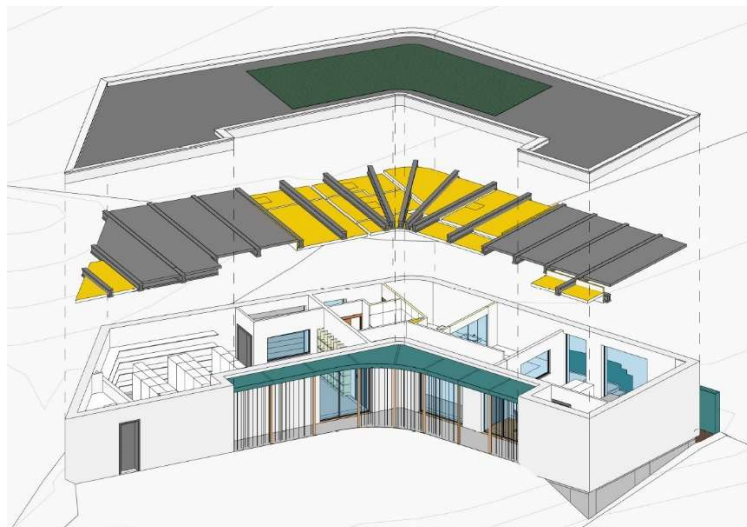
Vista explotada del proyecto piloto. Fuente: Autoría propia, 2021.
